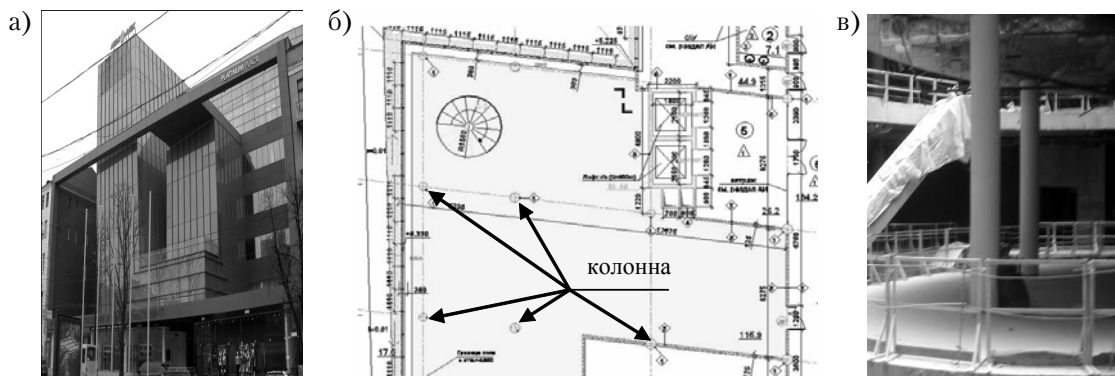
БЦ Platinum Plaza, г. Харьков, ул. Сумская, 72: а – фасад здания; б – фрагмент плана с расположением круглых колонн; в – процесс возведения конструкций типового этажа здания.
